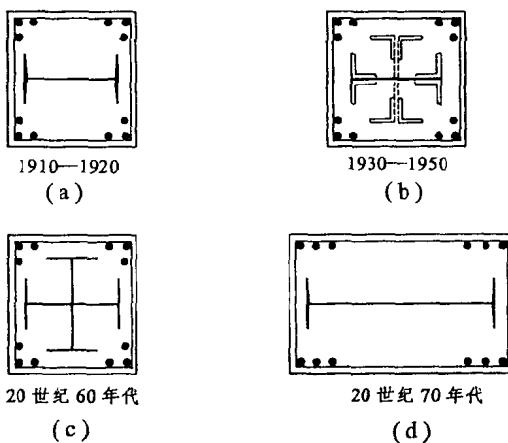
日本型钢混凝土结构中钢骨形式的变化
